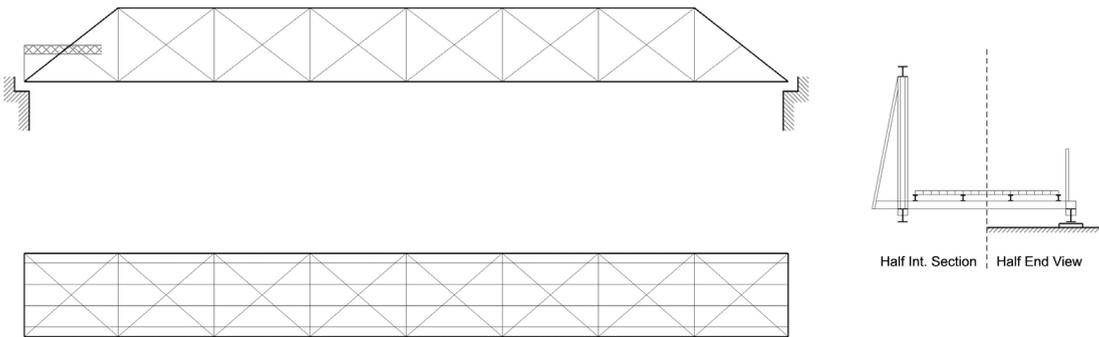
Puente metálico de armaduras sobre el río Guarinó, 1920.
